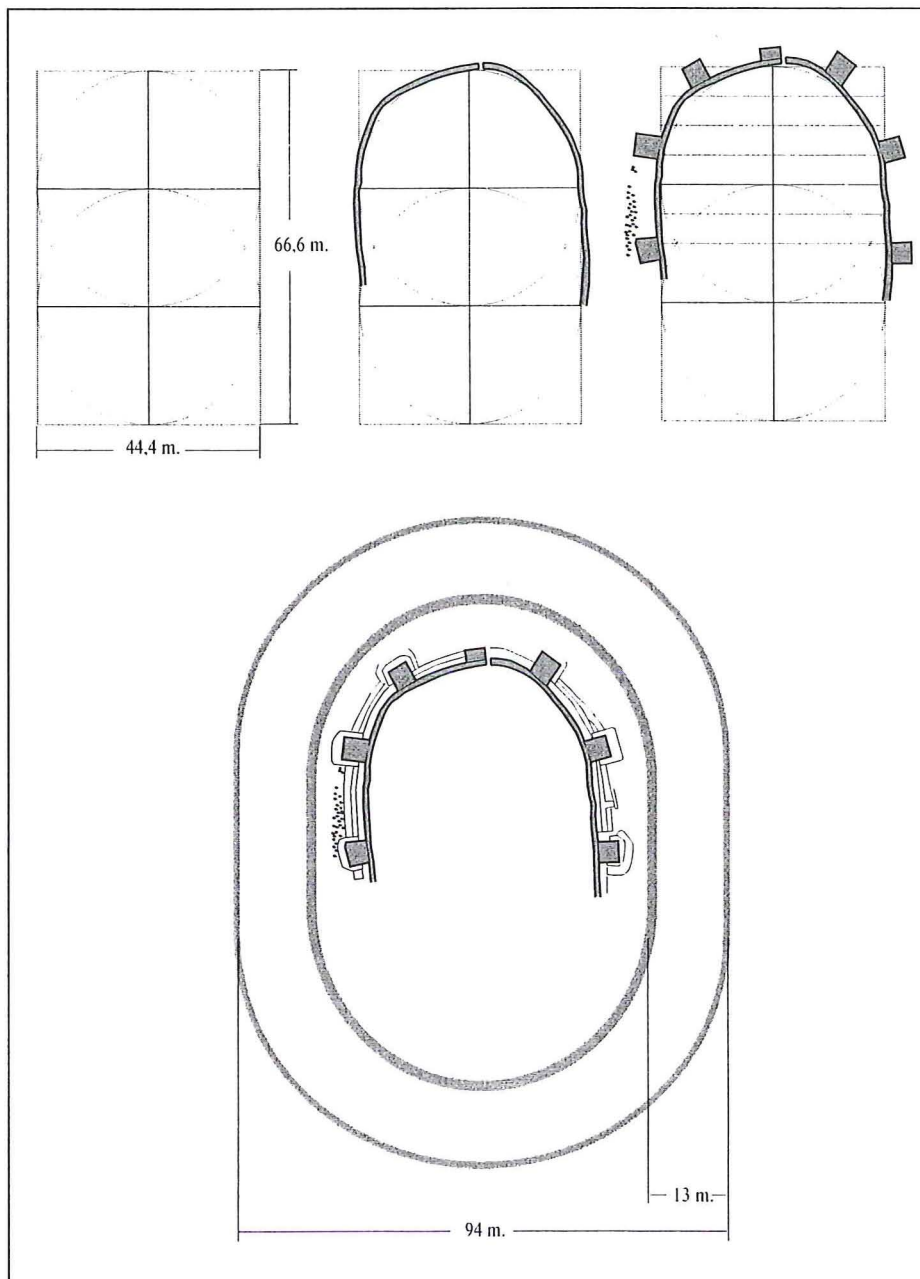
La planta de la fortaleza responde a un diseño calculado y fue previamente dibujada sobre el terreno.
